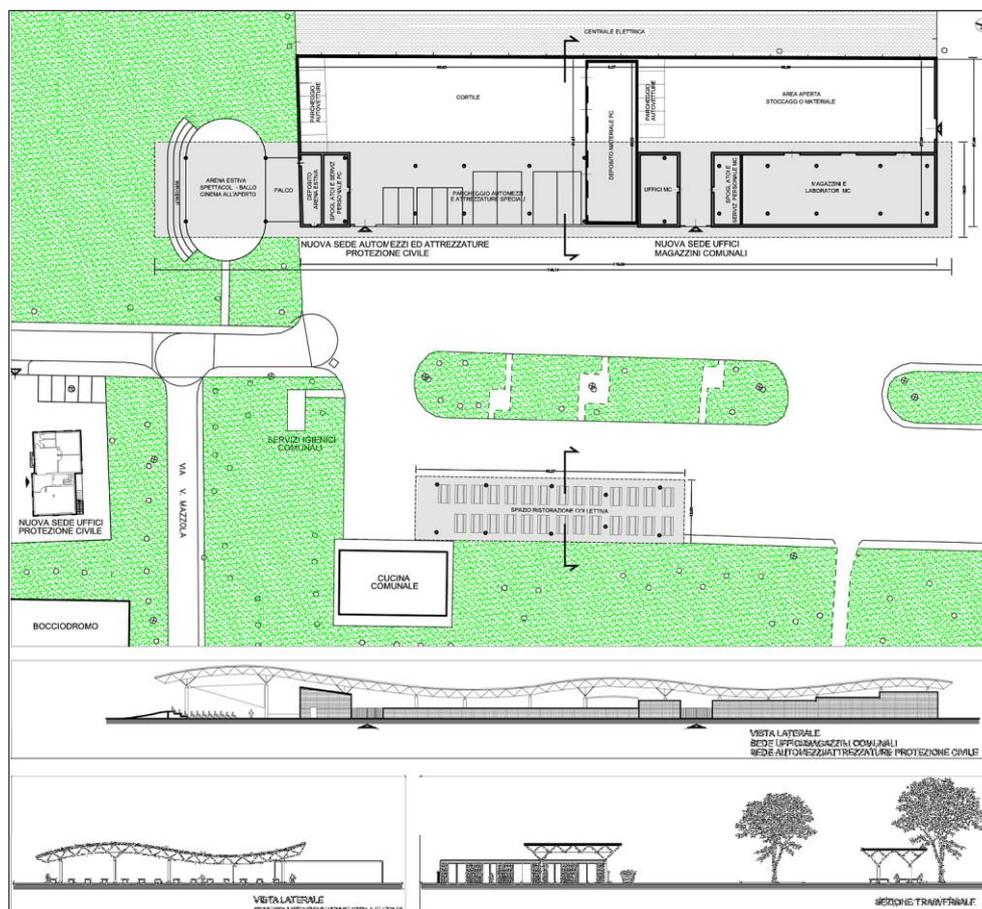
Planimetria di progetto (fonte Relazione Tecnica Arch. Andrea Savio)
